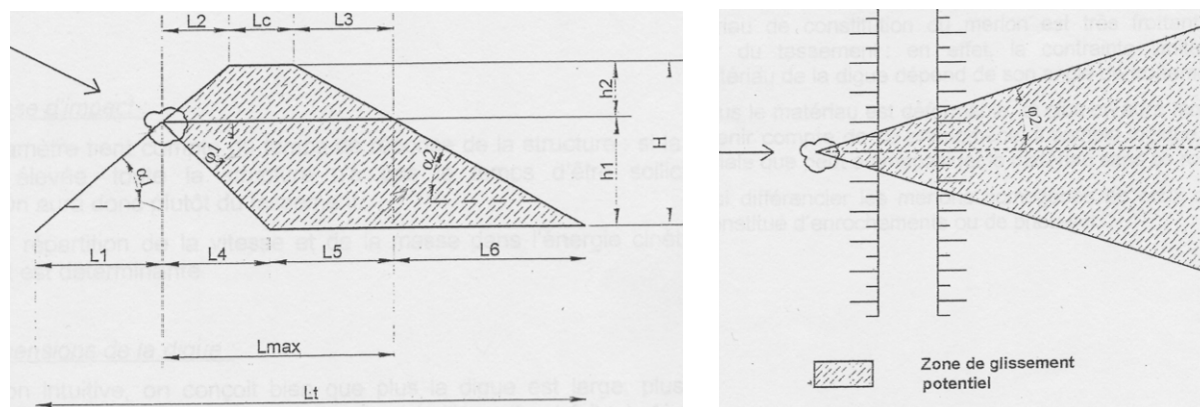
Profils des plans de rupture lors de l'impact d'une digue, d'après Jarrin 2001. Coupe schématique d'une section verticale (à gauche) et horizontale (à droite).
